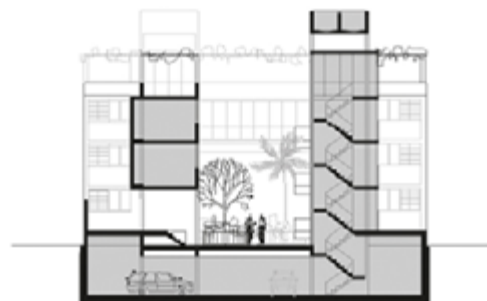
Corte transversal. Fuente: La Plata Arquitectura Moderna.
